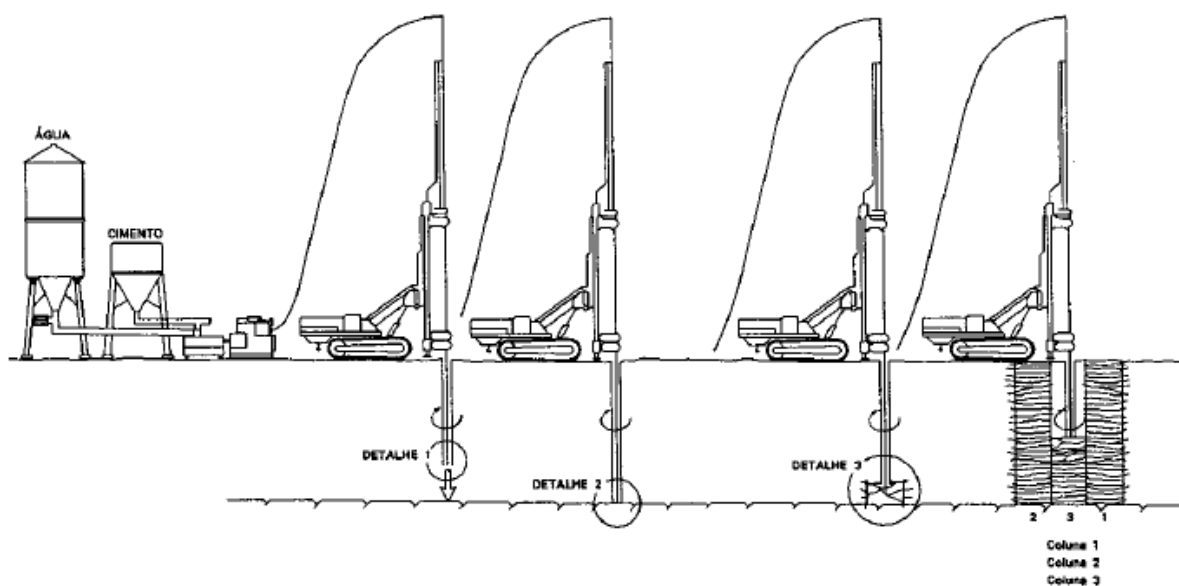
Esquema de execução da técnica de jet grouting (Carreto, 2000).
